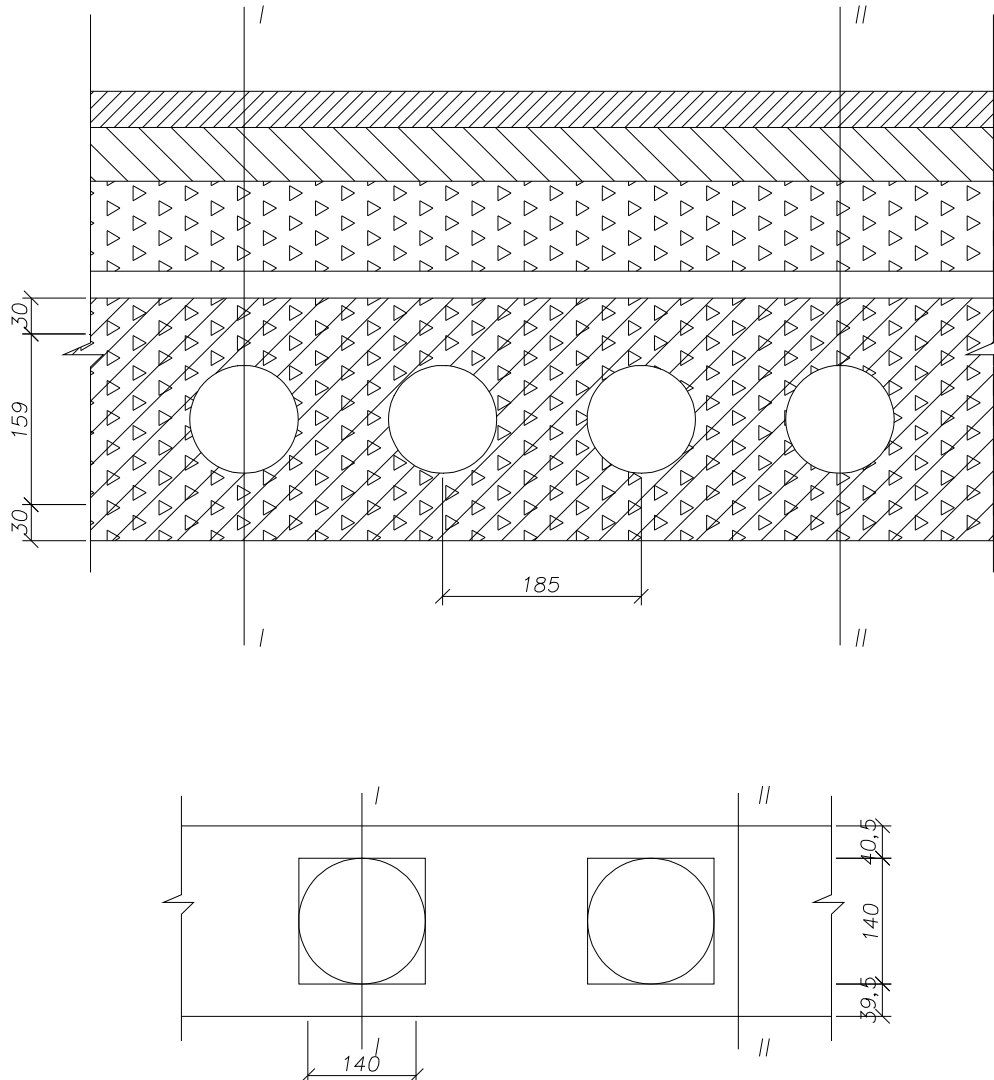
Розрахункова схема до розрахунку опору теплопередачі перекриття
